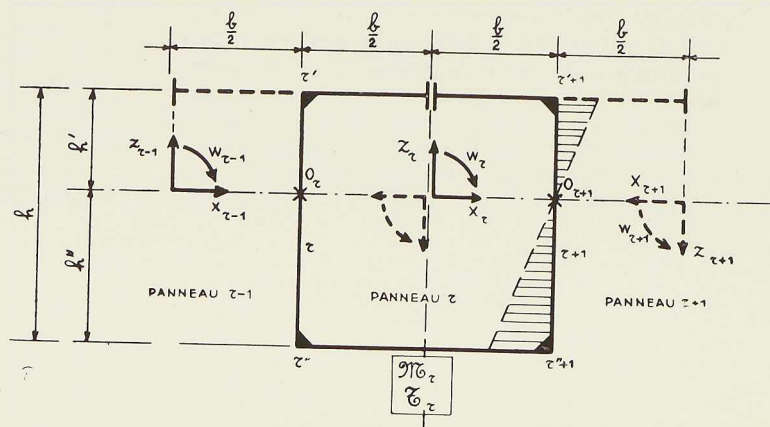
Etude des pièces constituant le panneau r de la poutre de la figure 601.
